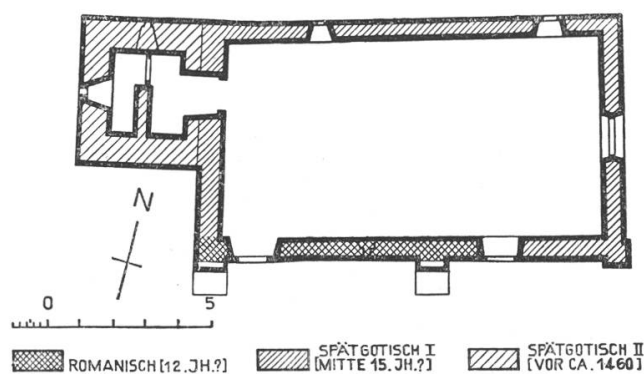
Remigen. Kirche. Grundriß, Maßstab 1 : 300
